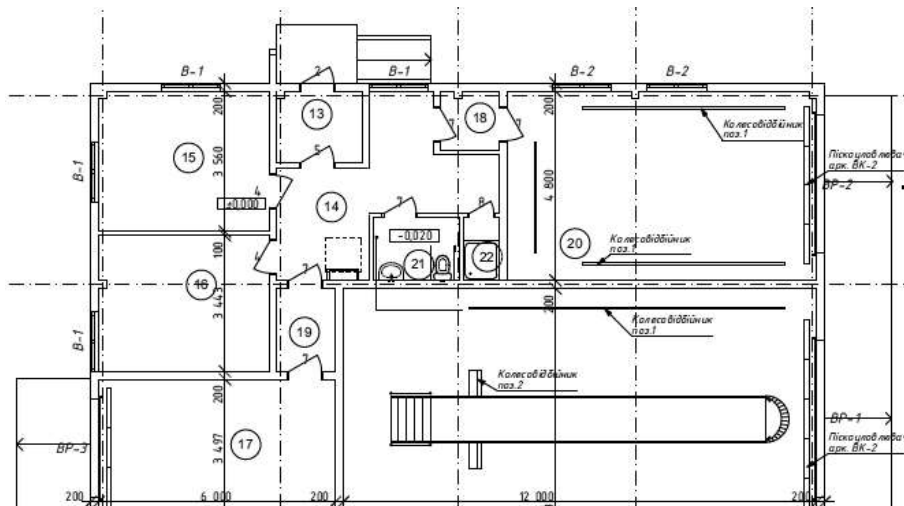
Фрагмент плану першого поверху центру громадської безпеки.
